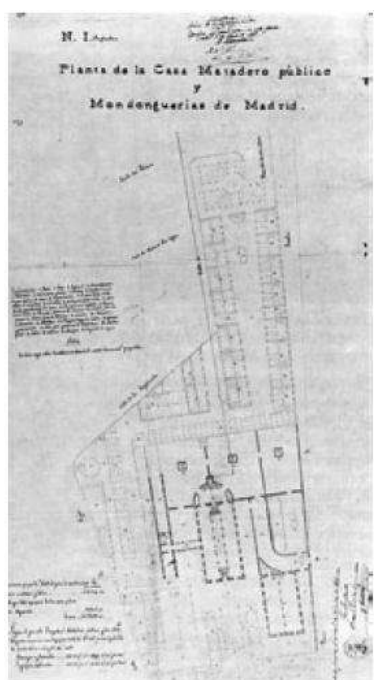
Planta del Proyecto de Casa Matadero de la Puerta de Toledo. Arquitecto: Juan José Sánchez Pescador, 1861 (AVM. 4-2)
